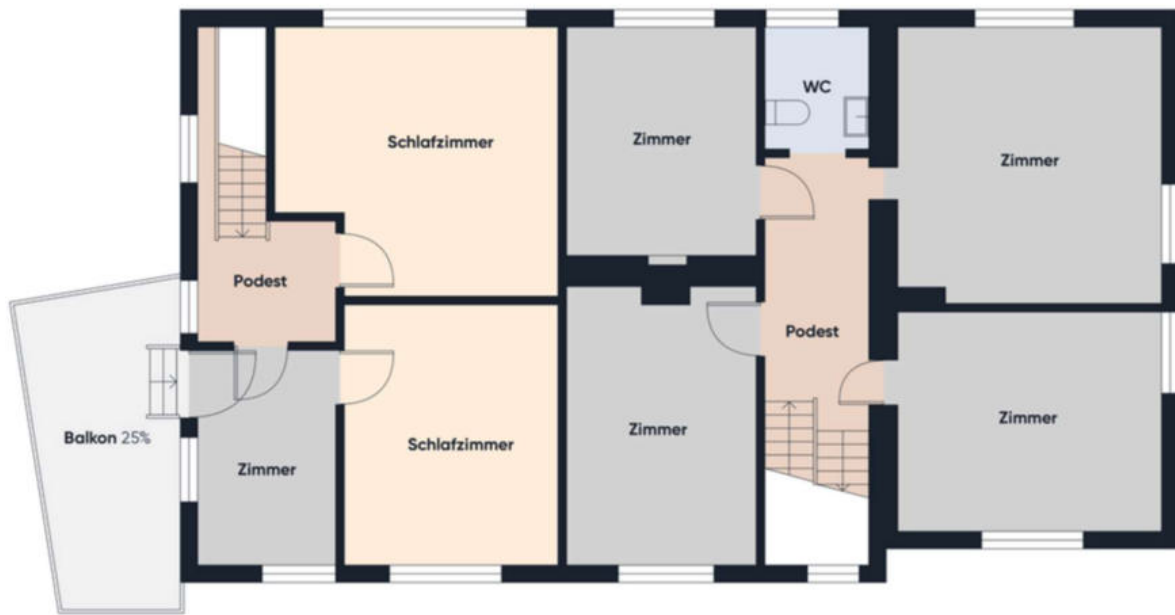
Grundriss 1. Obergeschoss Lidar-Messgerät zum Stichtag 2025
